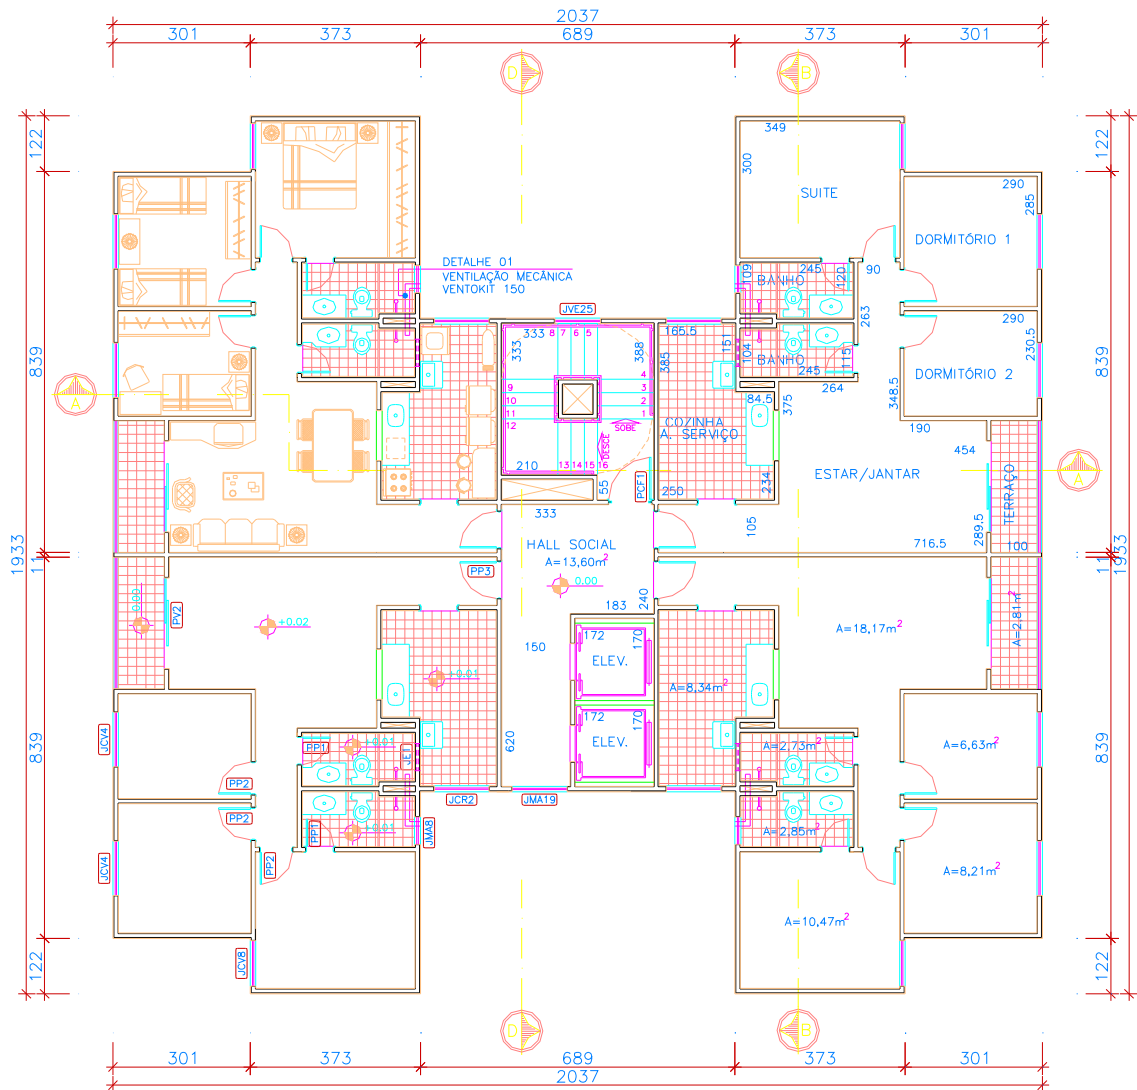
Planta do pavimento tipo do pavimento analisado.
